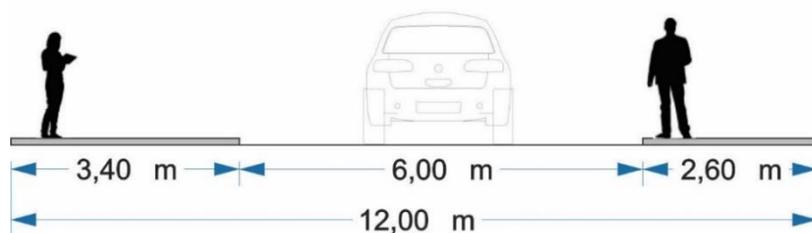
Levantamiento perfiles vialesFuente: (Elaboración propia, 2020)
